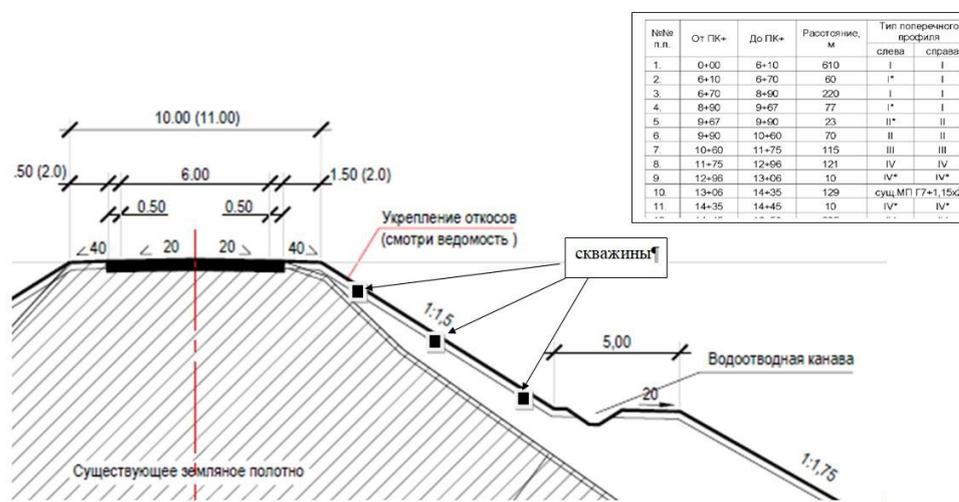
Схема забора проб грунта на откосе насыпи ПК 12 + 60 и ПК 12 + 80
